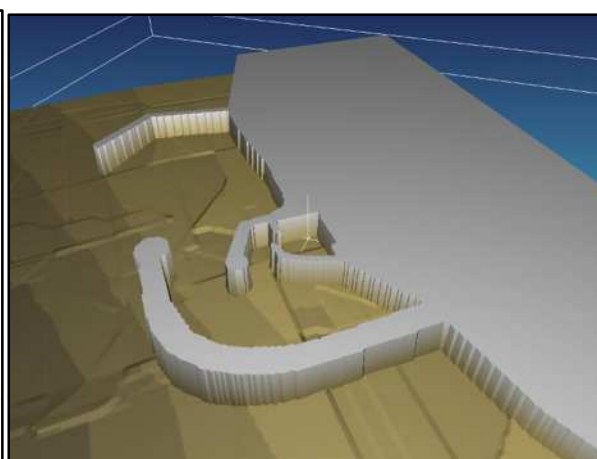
Plan de masse de la variante 3 en trois dimensions
